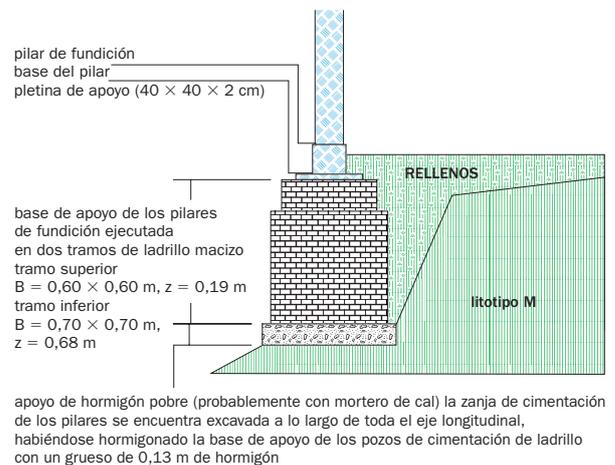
Secció de fonament del pilar central. | Sección de cimiento del pilar central.
